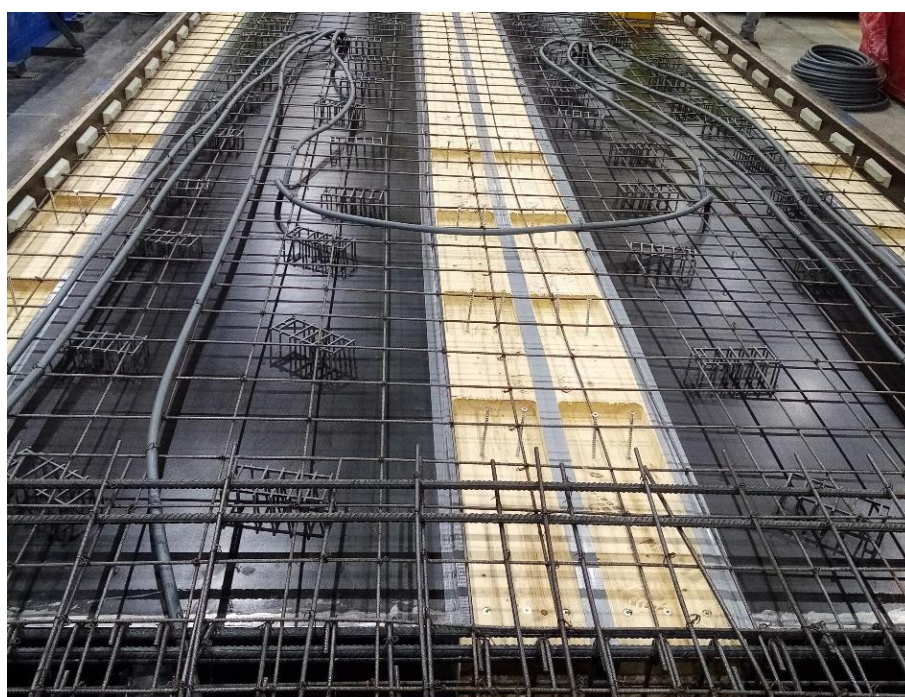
Produção do painel de laje - Instalação de tubagens de eletricidade
